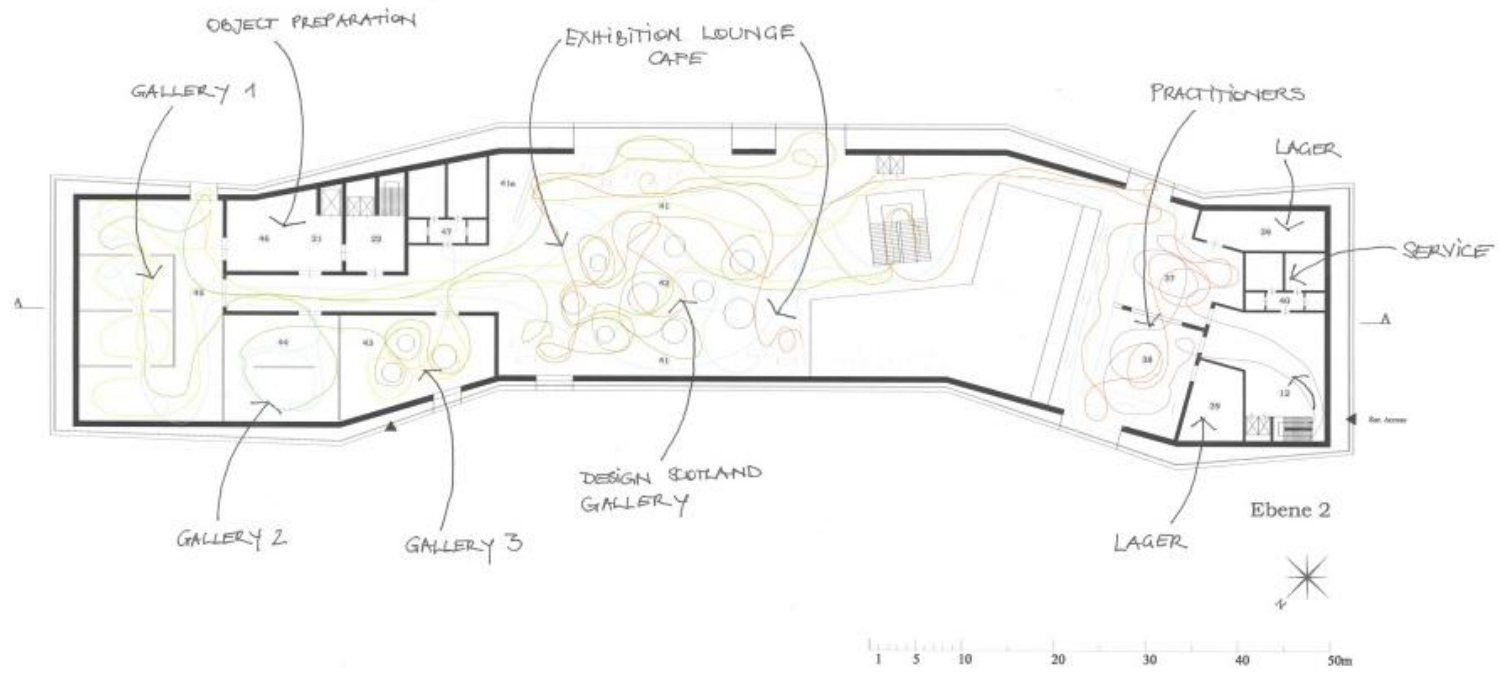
Übersicht Grundriss Ebene 2, Besucherwege
